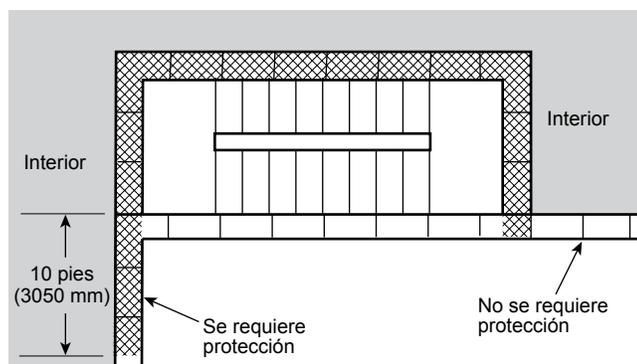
(c) Escalera con muro exterior no certificado expuesto por el muro adyacente exterior del edificio.
